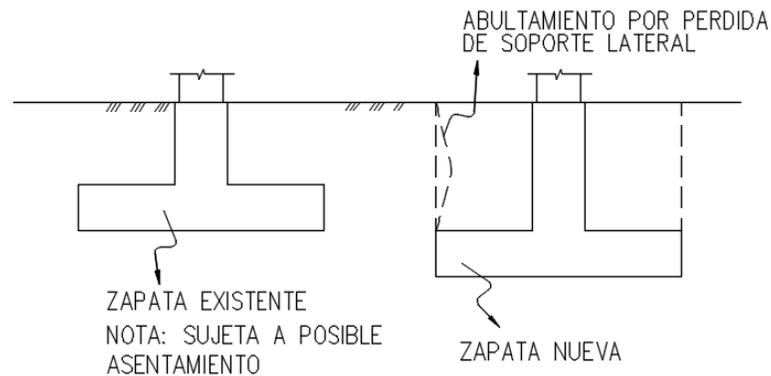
Separación entre zapatas nueva con respecto a una existente, por debajo de su cota de su fundación. Fuente: Autores
